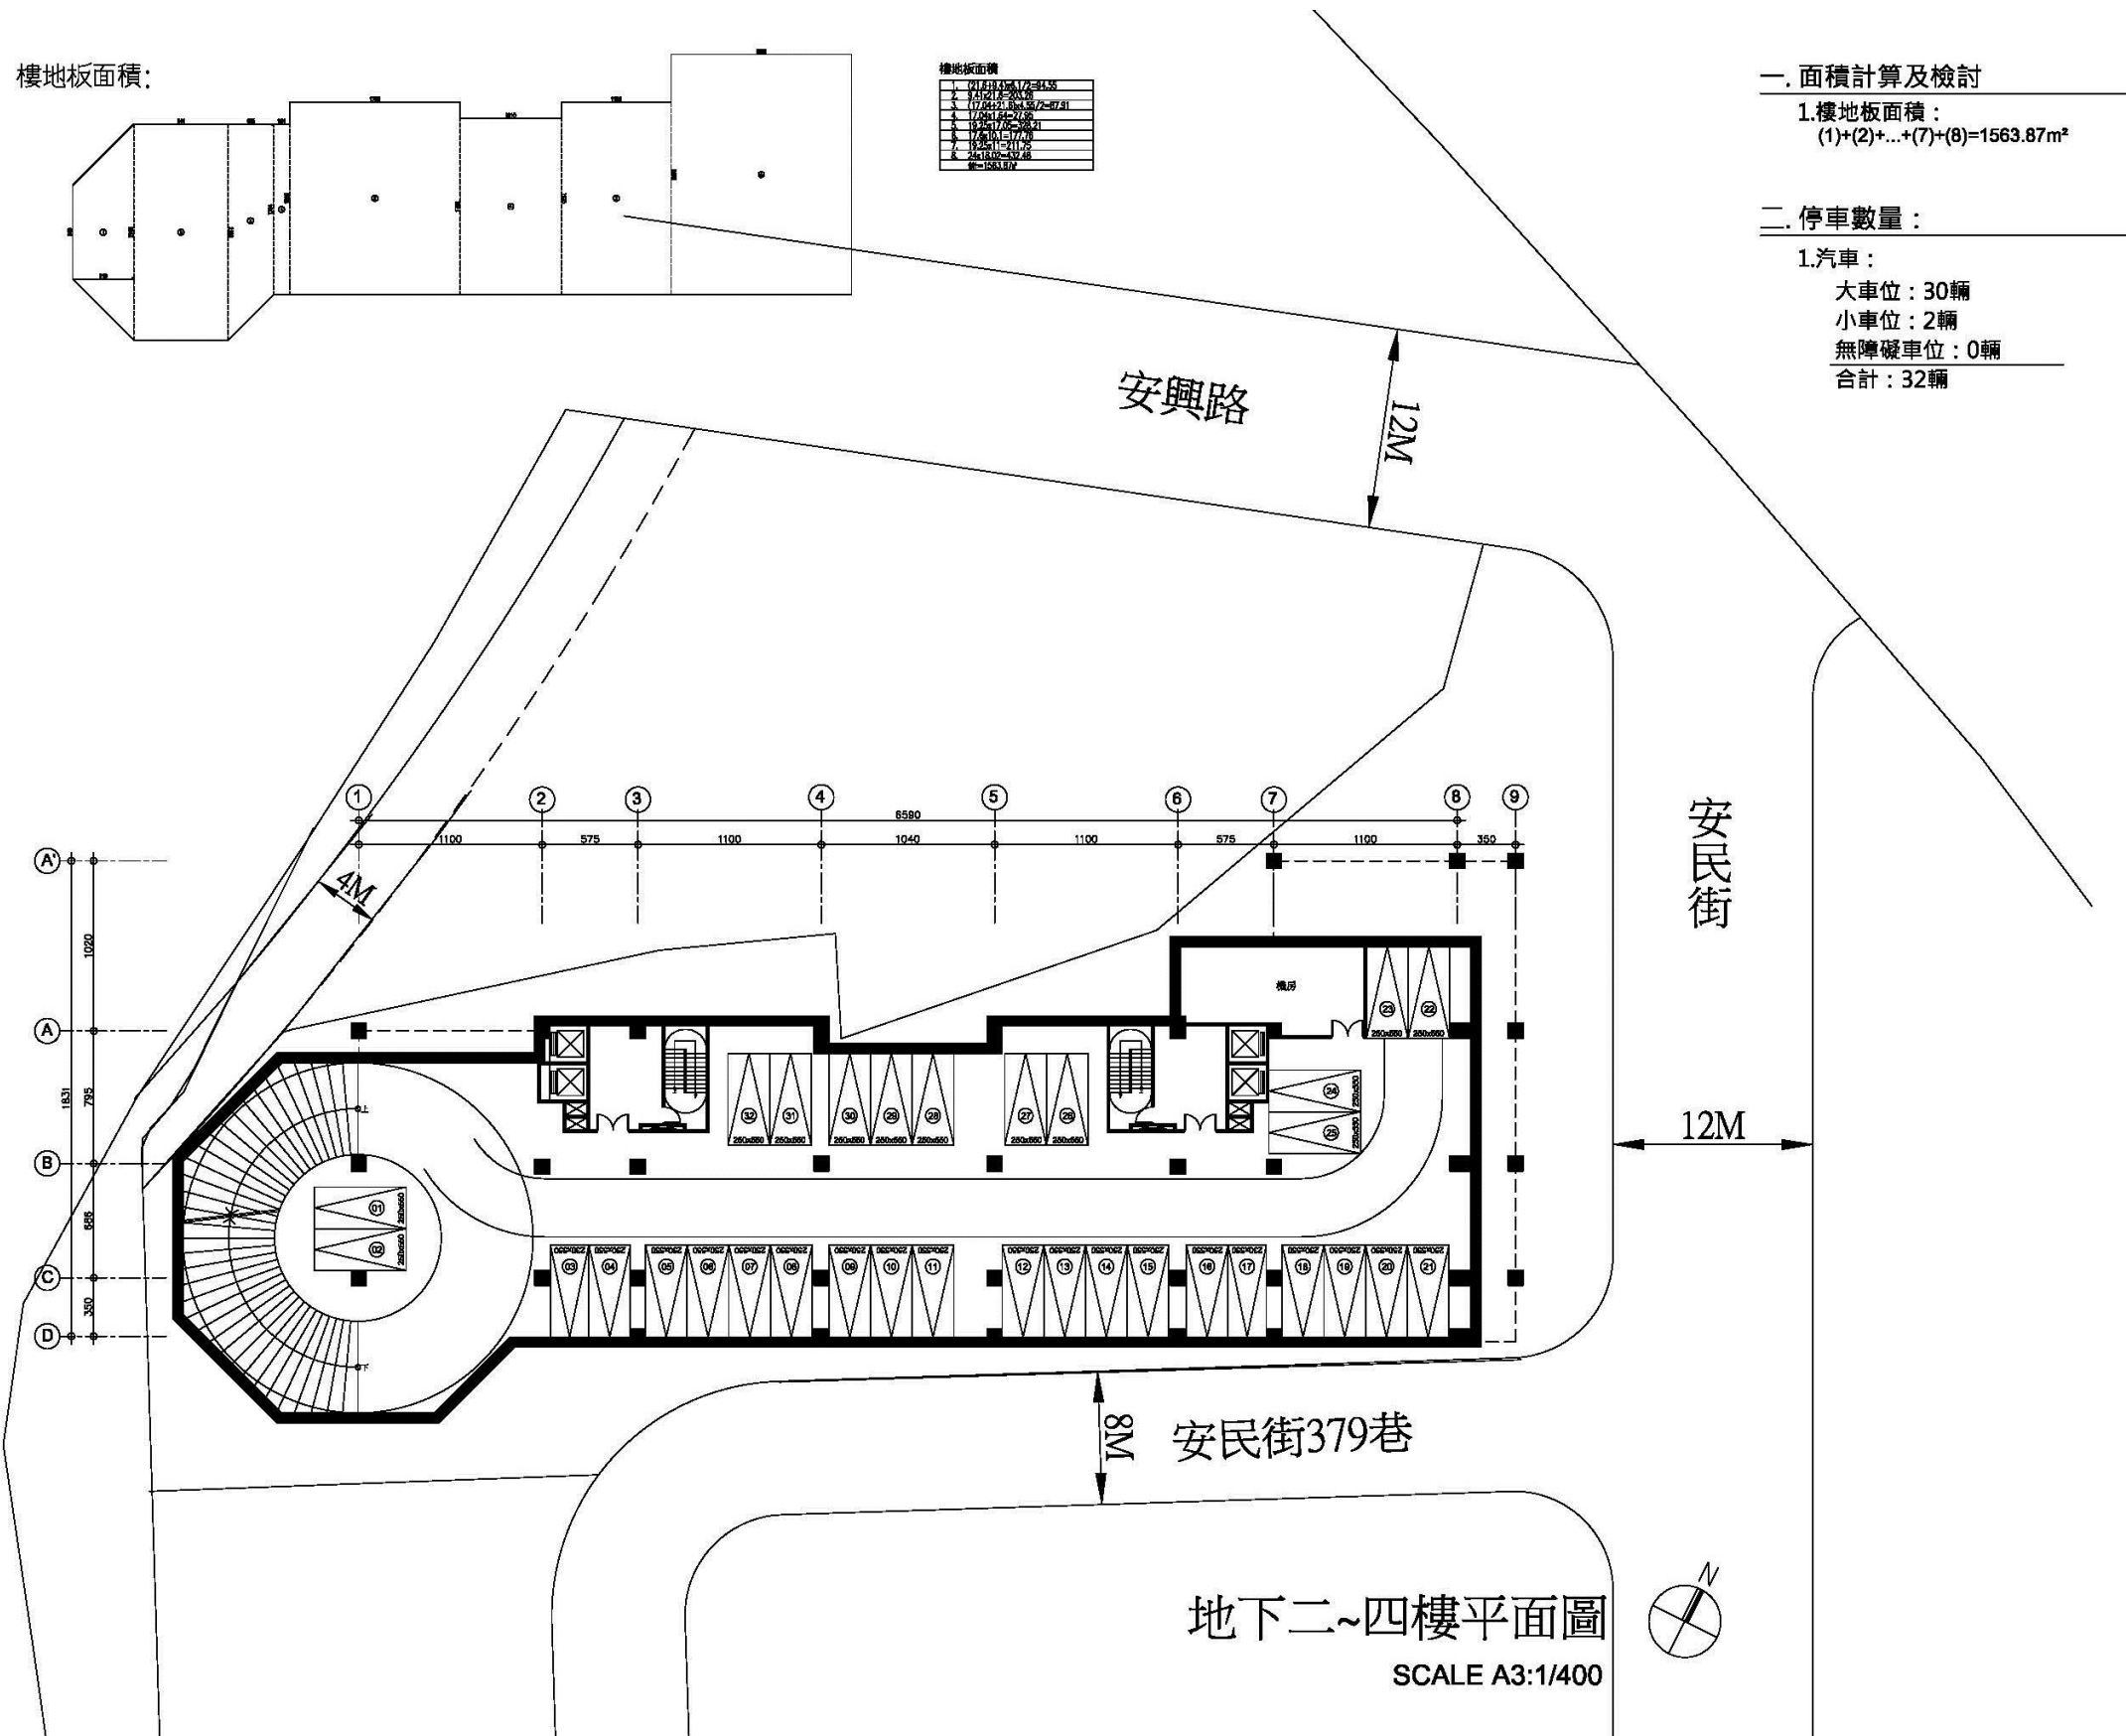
地下二~四樓平面圖 SCALE:A3:1/400
